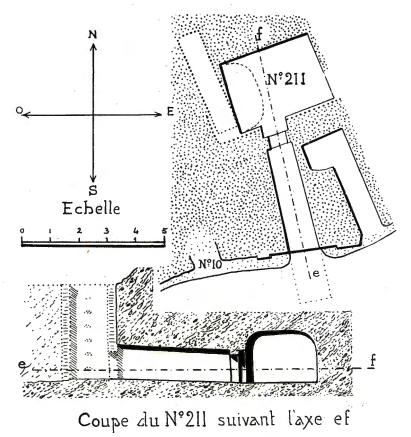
Plan et coupe de l'hypogée de la tombe n° 2111.
